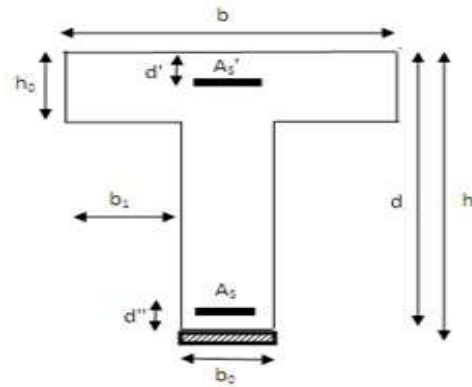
Géométrie d'une section en T d'une poutre en béton armé renforcée en flexion par composites CFRP.
